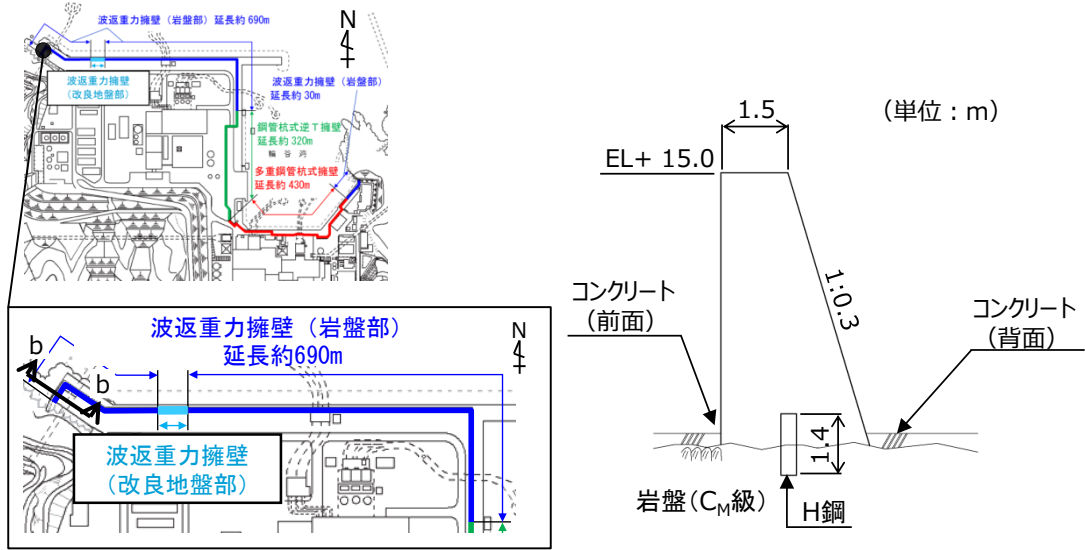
20 防波壁 (波返重力擁壁) 西端部 (b-b 断面) 断面図
